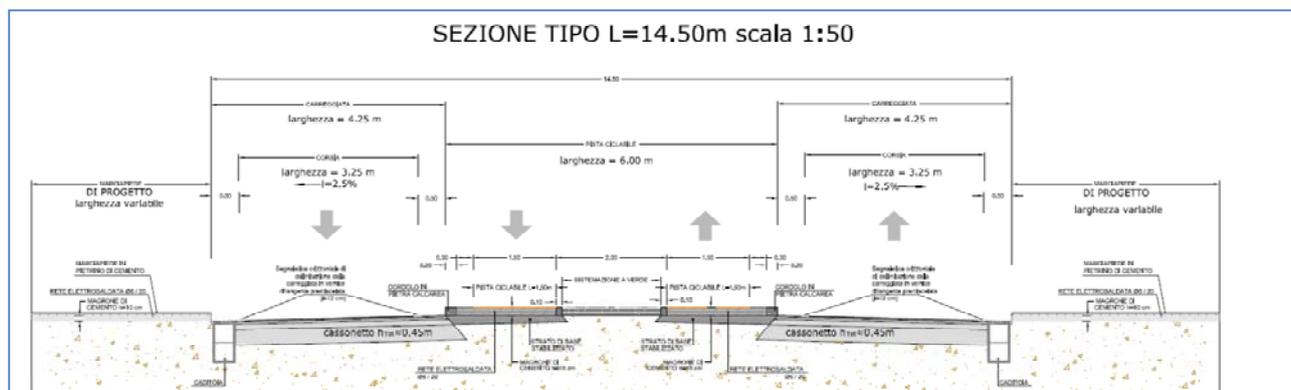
a Sistemazione tipo viabilità di progetto L=14.50 m
